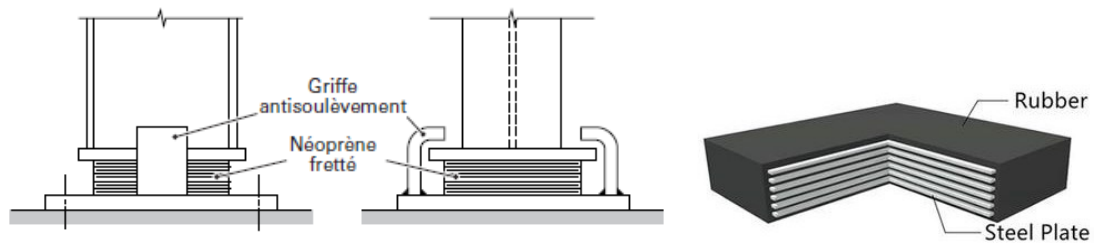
pieds de poteaux articulés avec dispositif avec appareil d'appui à élastomères frettés entre laques d'acier
